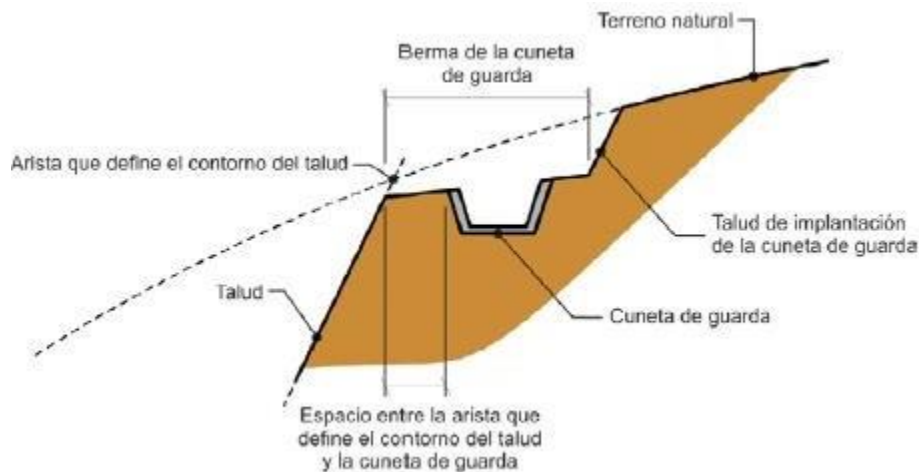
Detalle de una canaleta de drenaje superficial (Zanjas de coronación).
